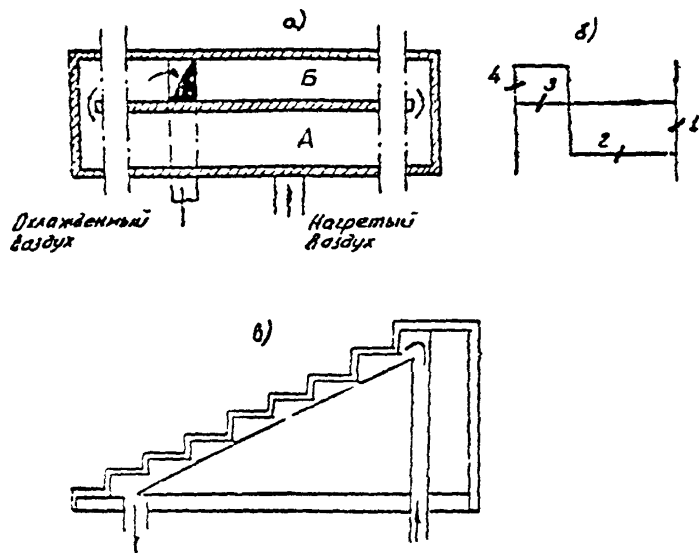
Рис. I. Схема подогрева наружных площадок и ступеней лестниц нагретым воздухом:
